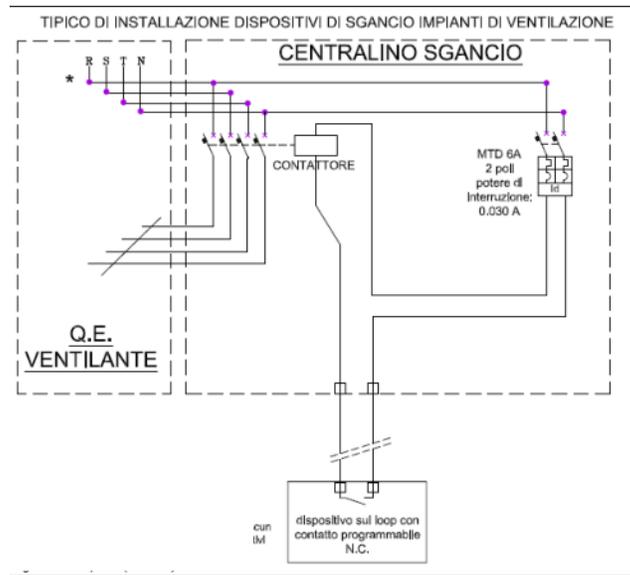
Schema di collegamento dispositivo di sgancio impianto di ventilazione
